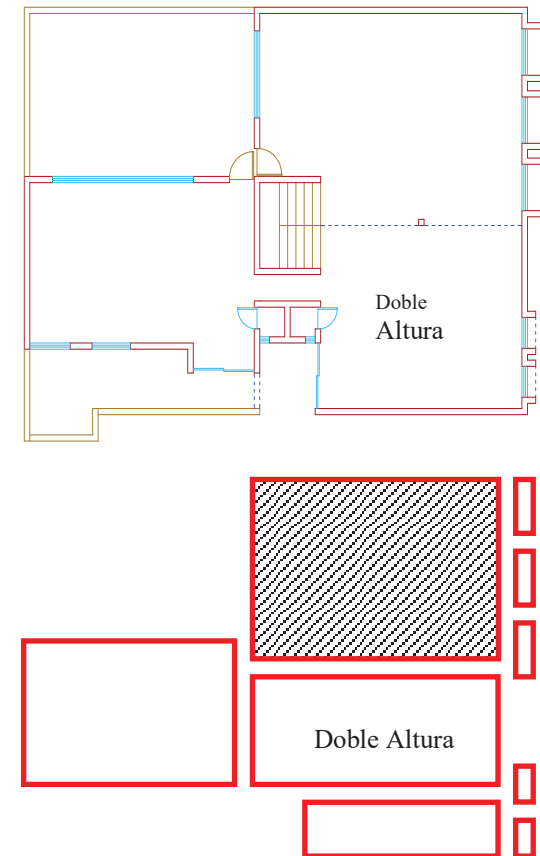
Planta baja, muestra la utilización de elementos rectangulares el cual se encuentran agrupadas entre si.
